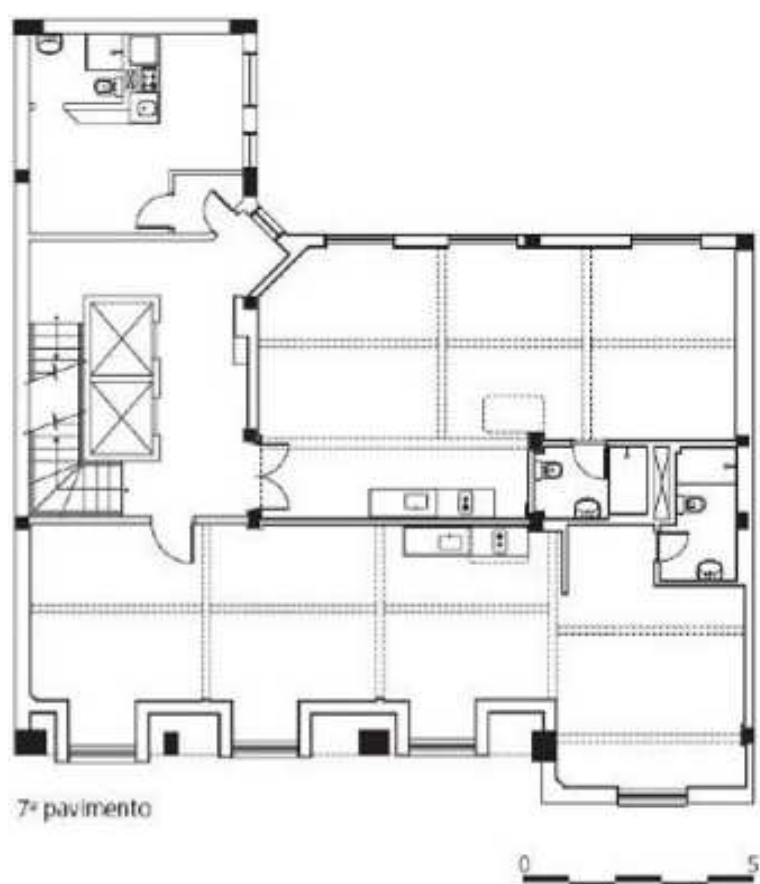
PLANTA PAVIMENTO 7, IMPLANTAÇÃO DOS LOFTS TIPO 1 E 2
